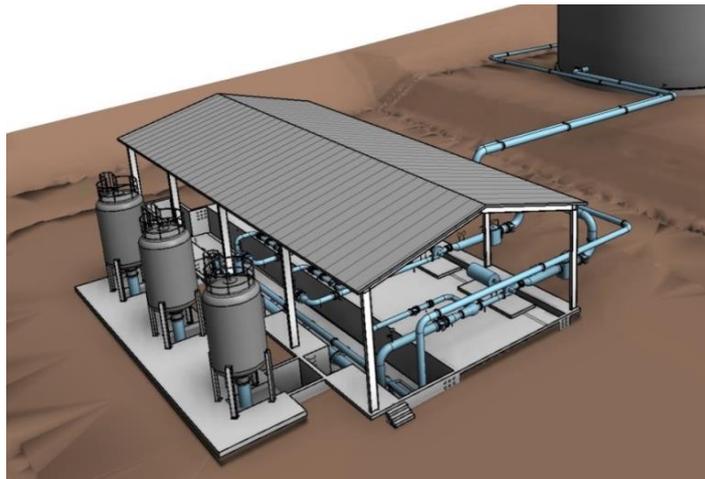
Modelo BIM da Estação Elevatória – vista 3D.
